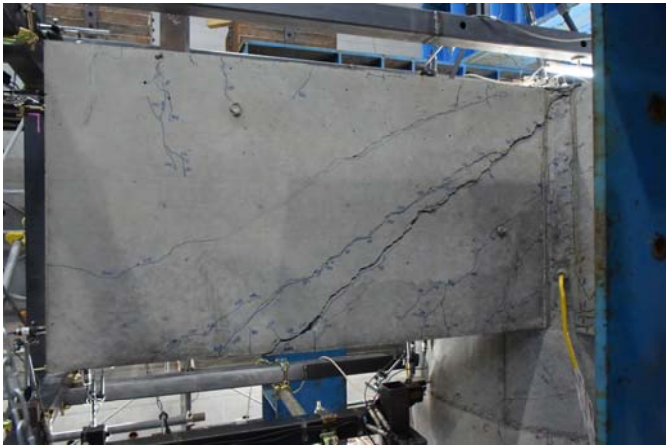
梁表面のひび割れ状況 (2-T)
